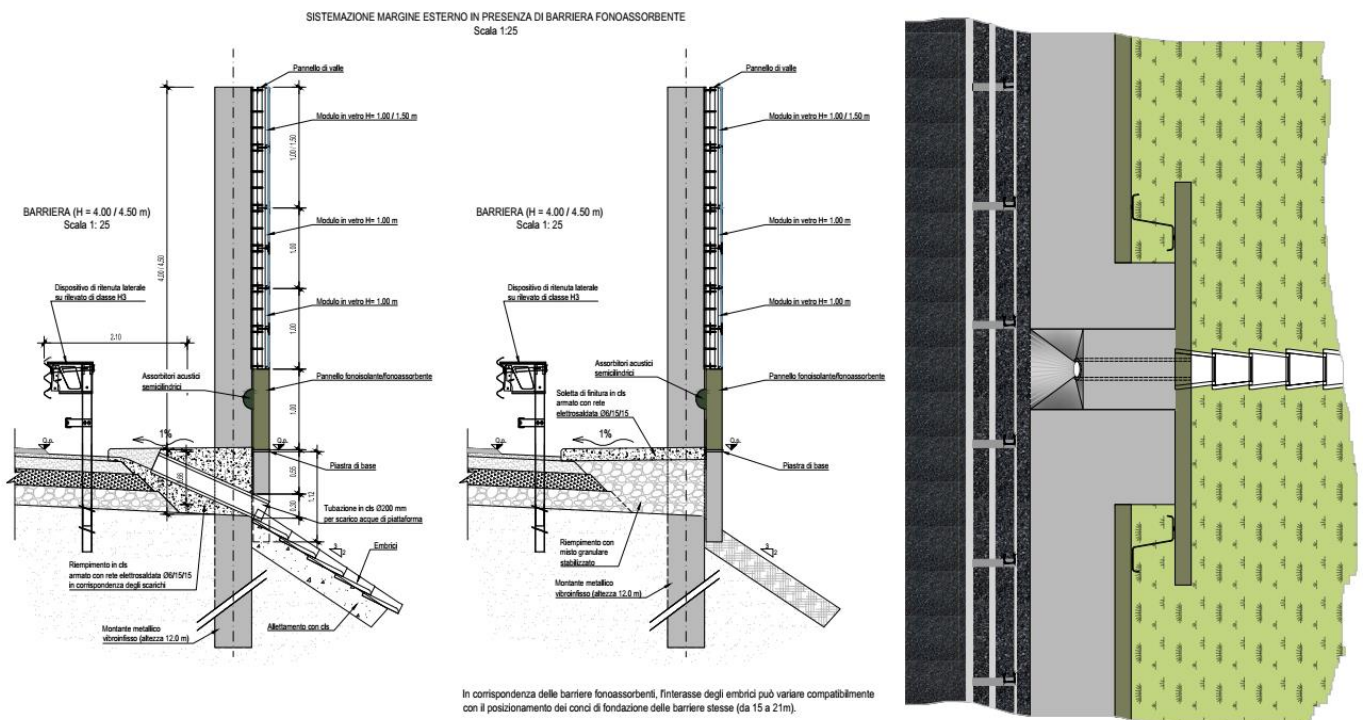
Sezione tipo barriere fonoassorbenti
